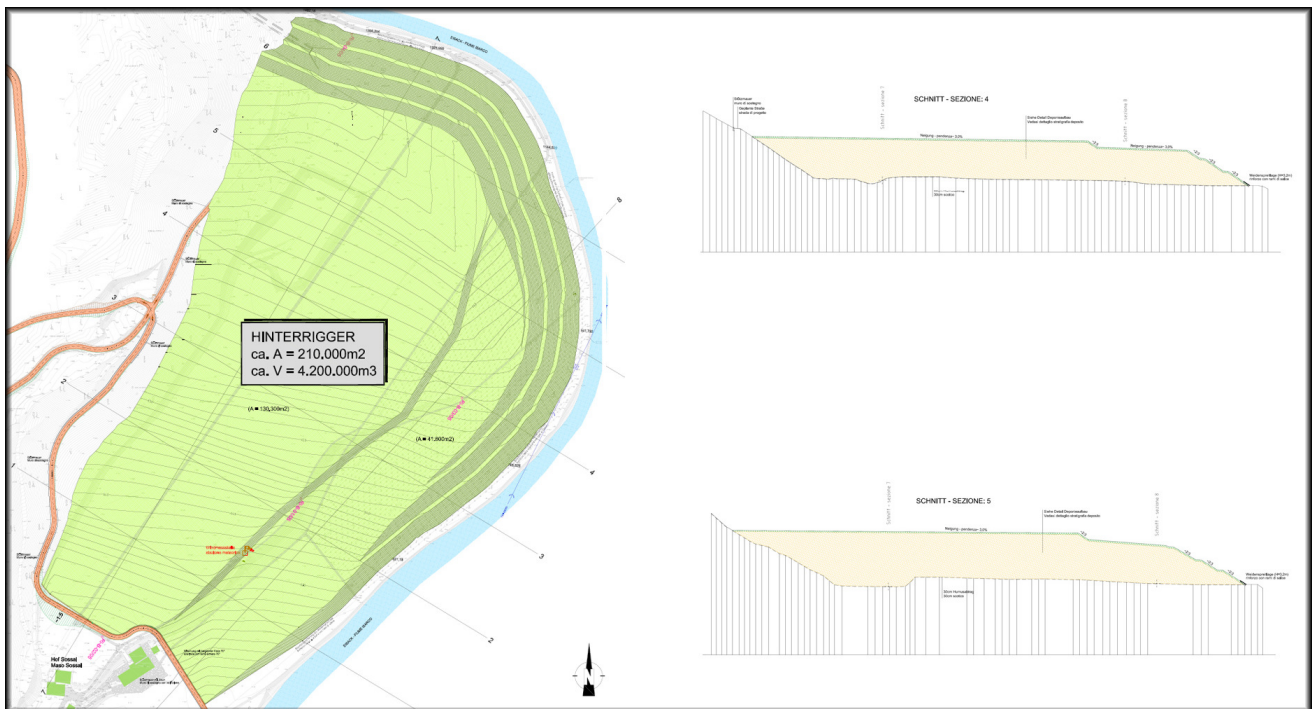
Lageplan und regelquerschnitt deponie Hinterrigger
